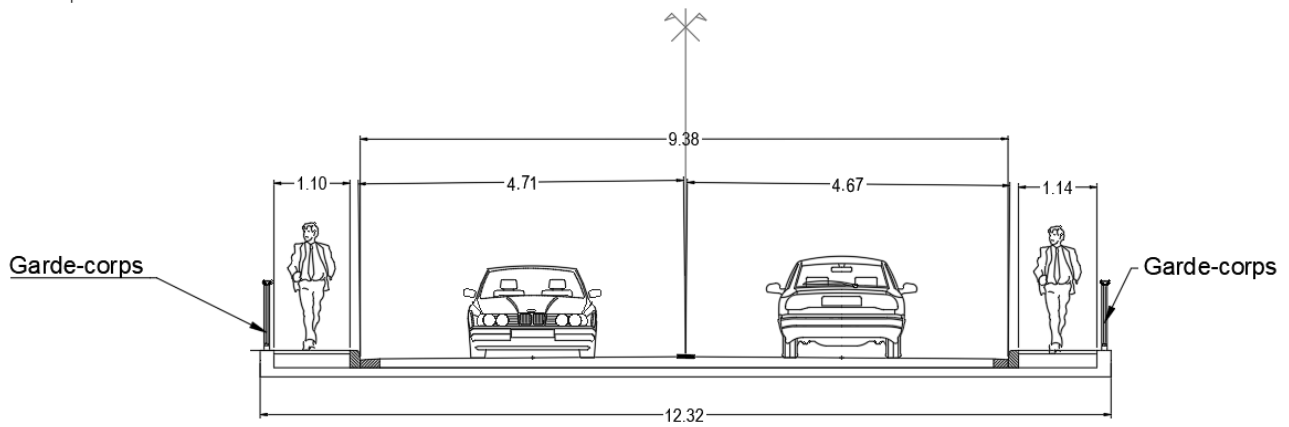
PROFIL EXISTANT SUR L'OA DE LA RD6
